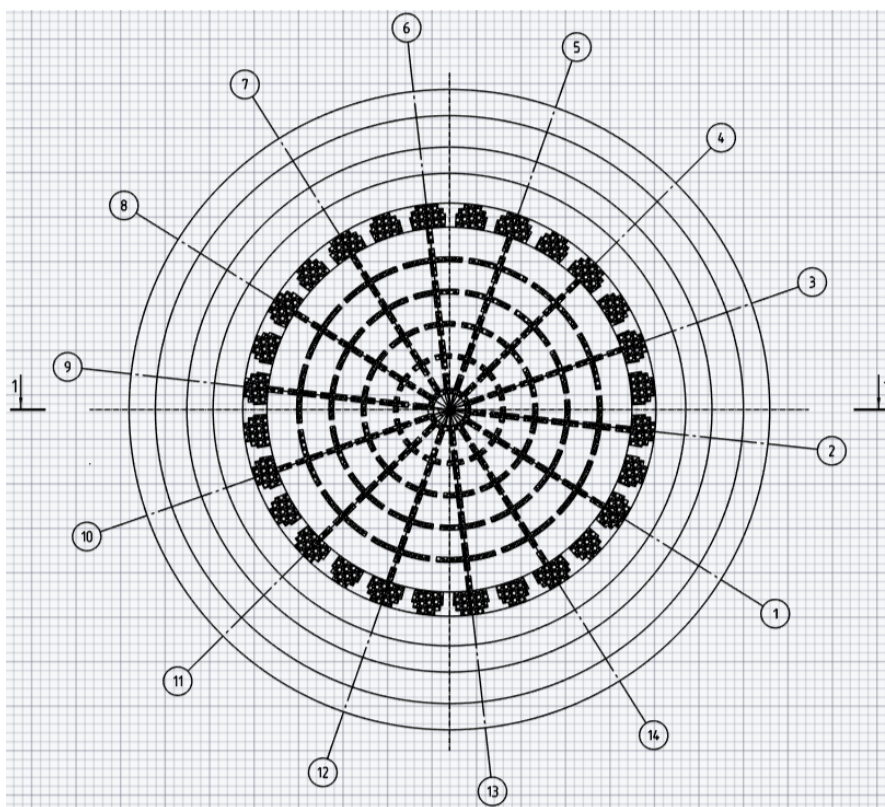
Общий план 5-го этажа Вавилонской башни
